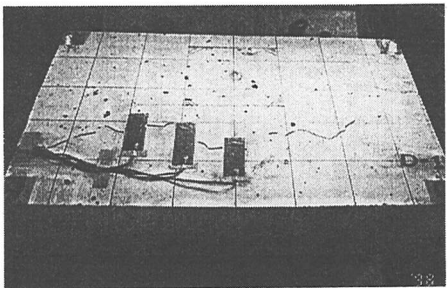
D-1 体のコンクリート床版上面のひび割れ
